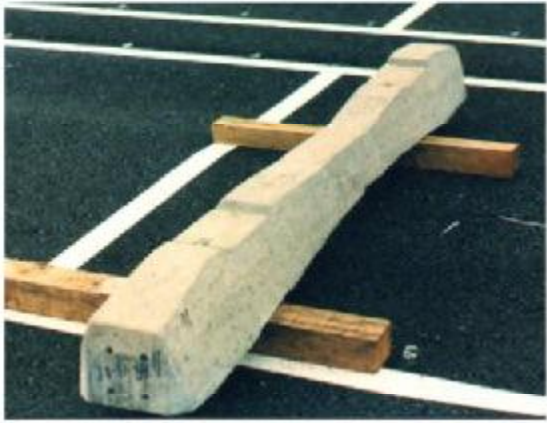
FOTOS OUTRO BETÃO PRÉ-FABRICADOS
